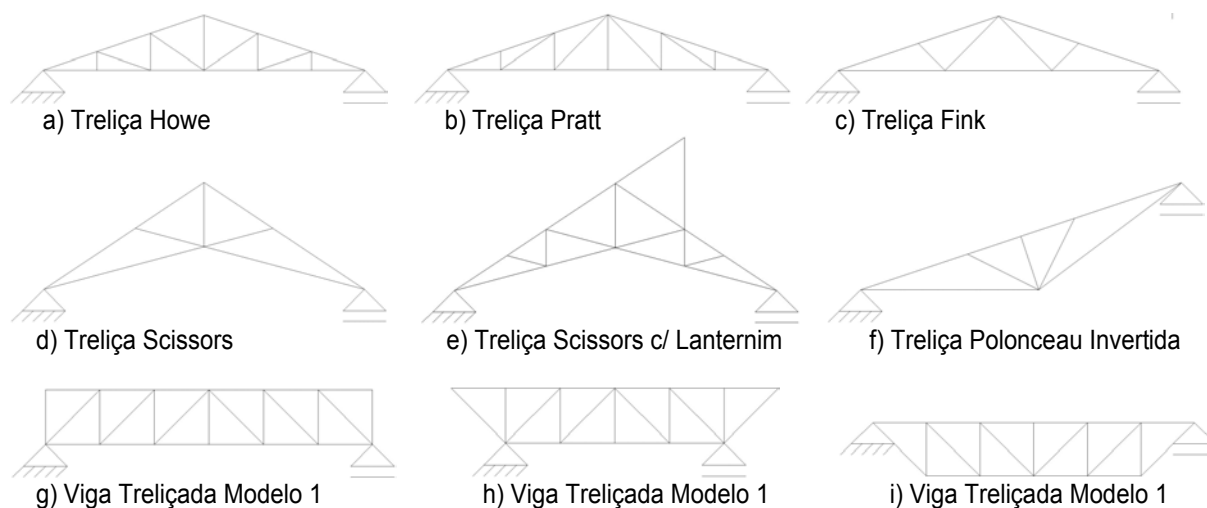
Tipos de treliças planas usuais em projetos de coberturas com madeira roliça.
